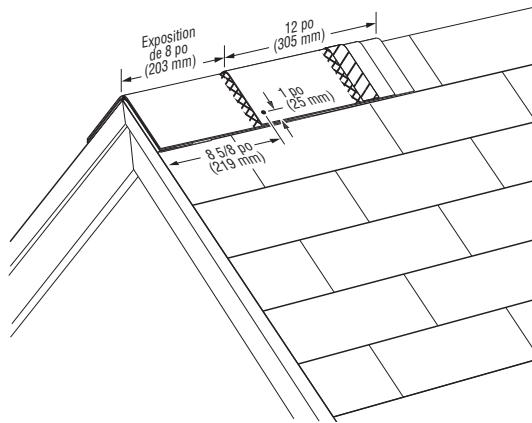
Poser les bardeaux de toiture en laissant une exposition de 8 po (203 mm) et planter un clou de chaque côté de la façon indiquée.
